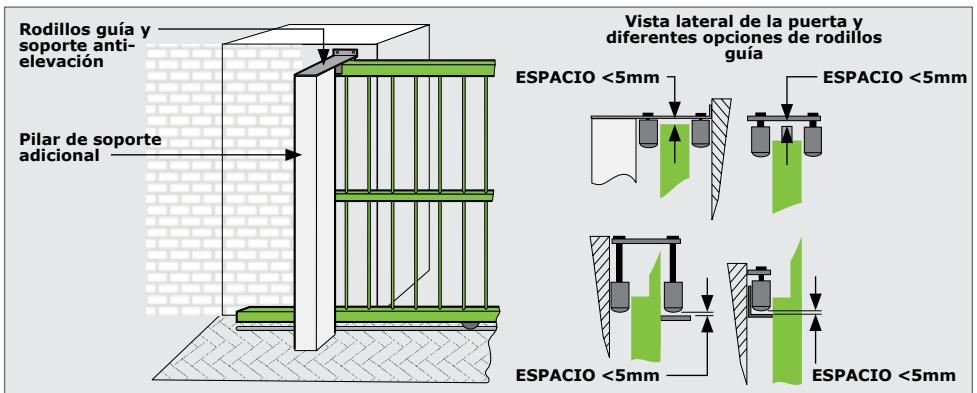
MONTAJE DE RODILLOS GUÍA
